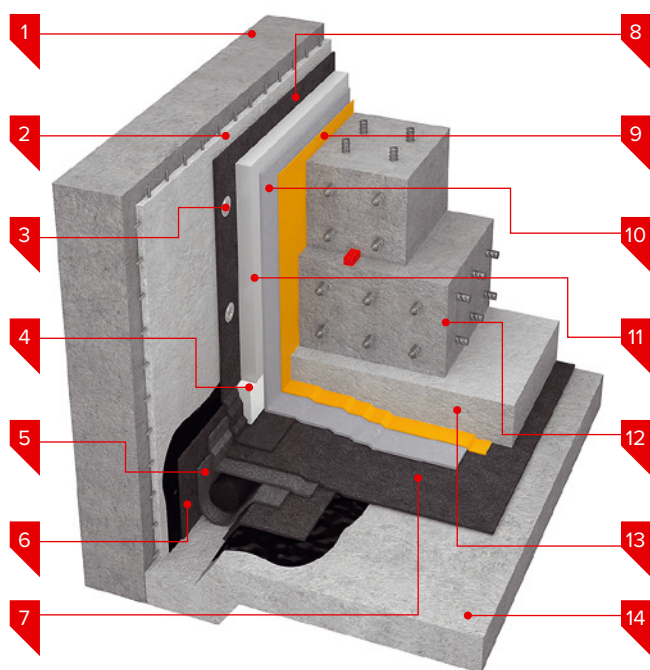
Техноэласт Фундамент ТЕРРА. Зона подошвы фундамента с дополнительным скользящим слоем.
